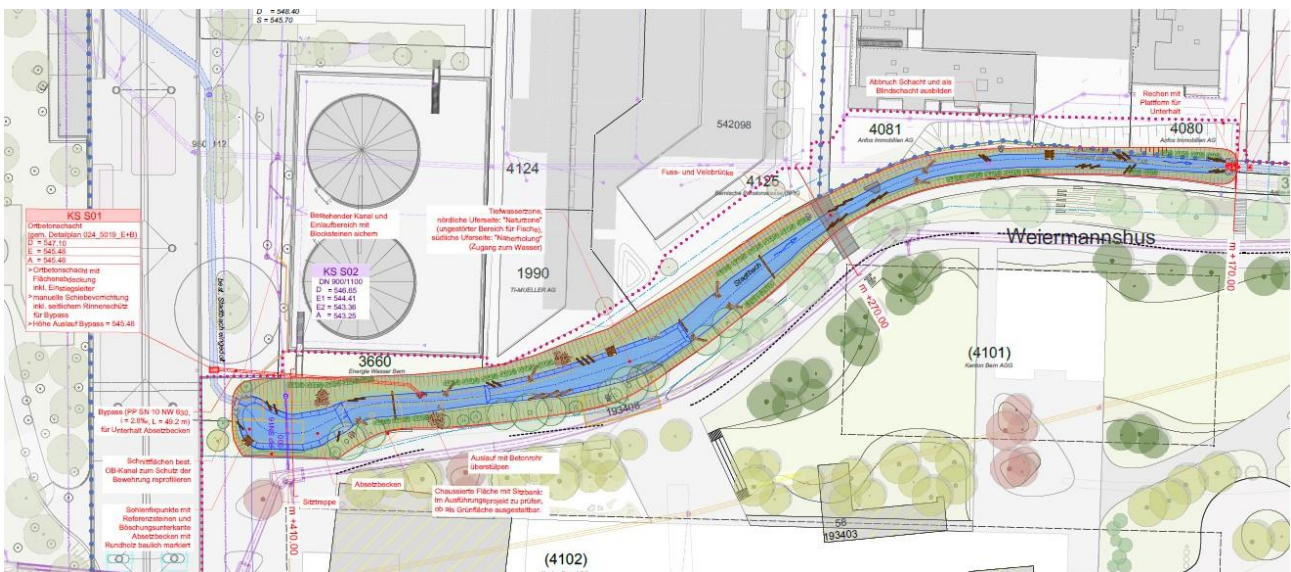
Ausschnitt Situationsplan Wasserbauprojekt Offenlegung Stadtbach (Chaves Biedermann, Bauprojekt, Projektstand Dezember 2022)
